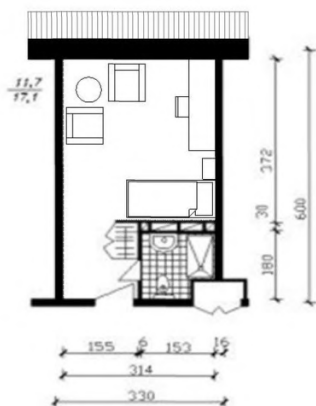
Планировка однокомнатного номера мансарды
